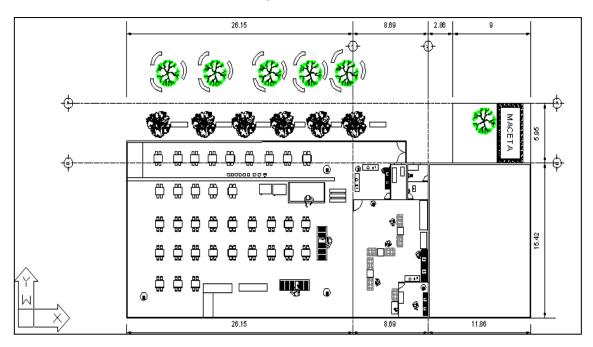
Vista en planta de la zona de estudio para la planta de biogás
